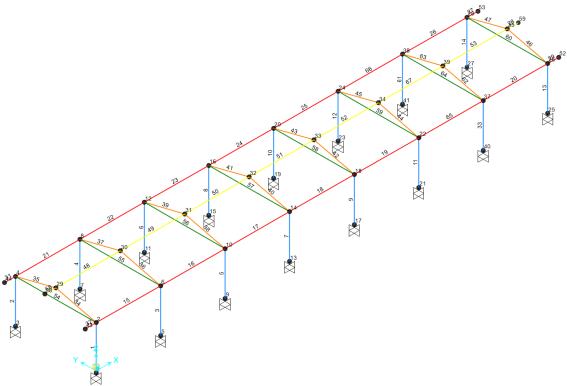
Vista assonometrica modello struttura in elevazione - numerazione elementi frame
